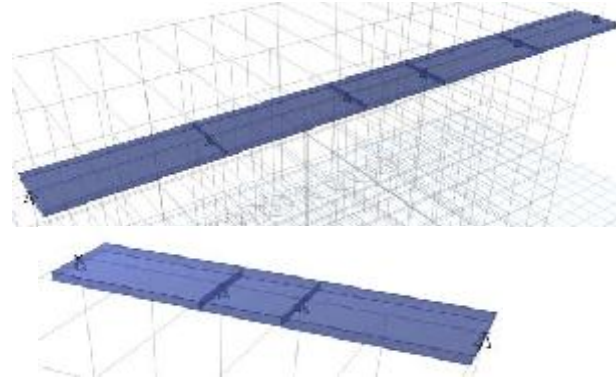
Modelo losa maciza de Pabellón Tipo I (izquierda) y Pabellón Tipo II (derecha)
